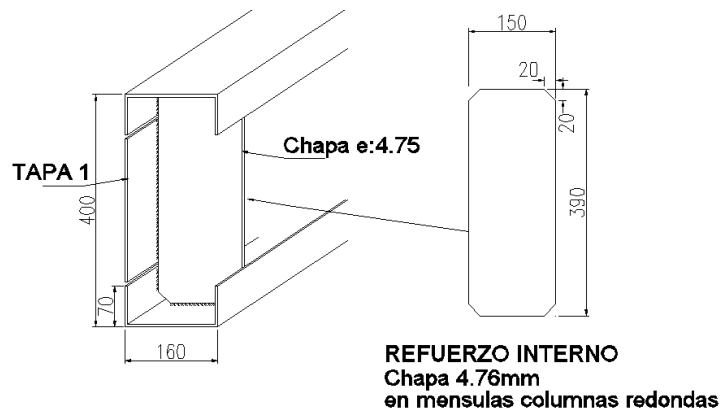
"Detalle de refuerzo para apoyo sobre columna"
